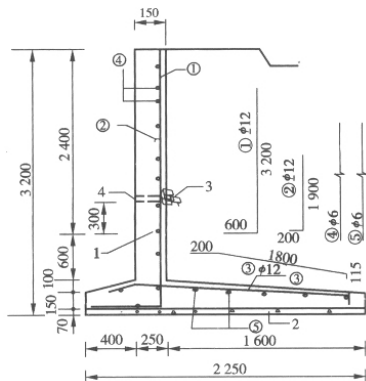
挡土墙大样图(尺寸单位:mm)
